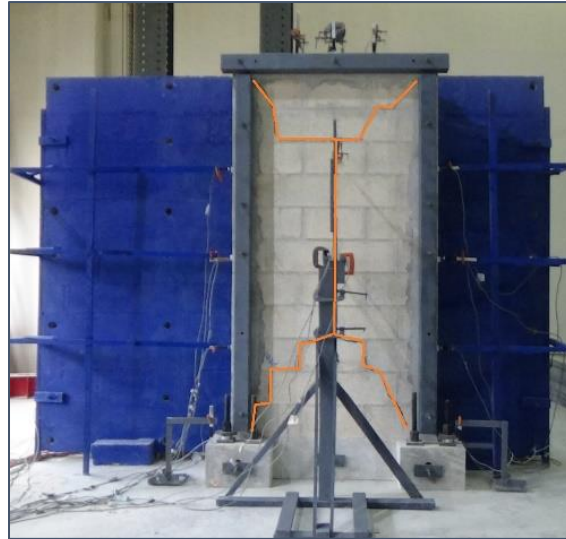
Patrón de agrietamiento final del muro M-2.0-0.
